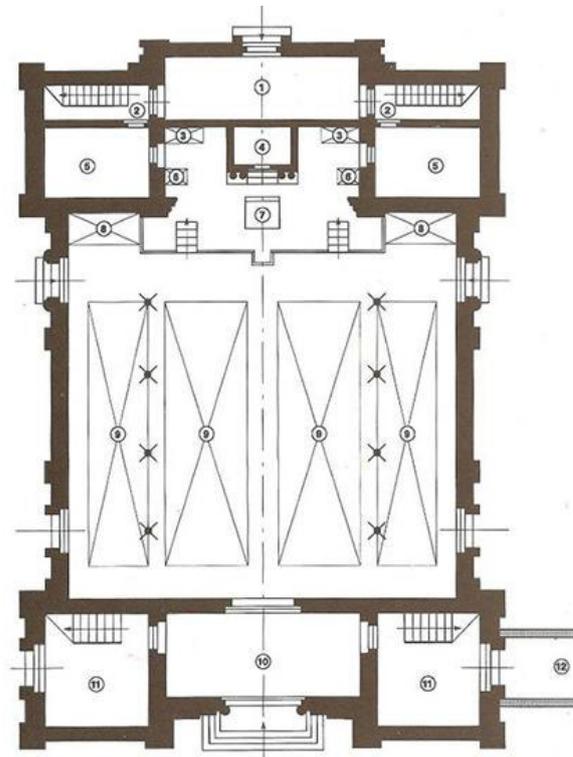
, Grundriss Bielsko-Biala / Myslowice
